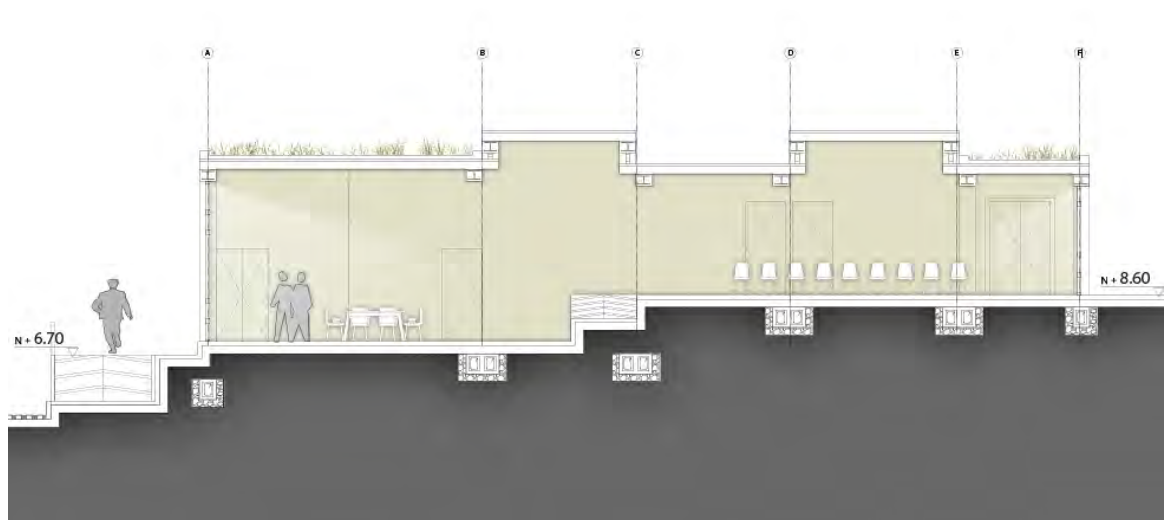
Corte B-B'2 – Fuente: Elaboración Propia
